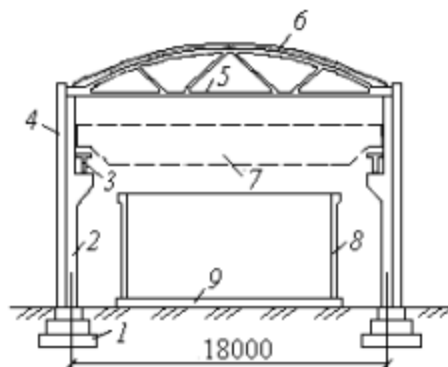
Поперечный разрез здания фильтров: 1 – фундамент; 2 – колонна крайнего ряда; 3 – подкрановая балка; 4 – стеновые панели; 5 – стропильная ферма; 6 – плита покрытия; 7 – мостовой кран; 8 – стеновые панели фильтра; 9 – днище фильтра
